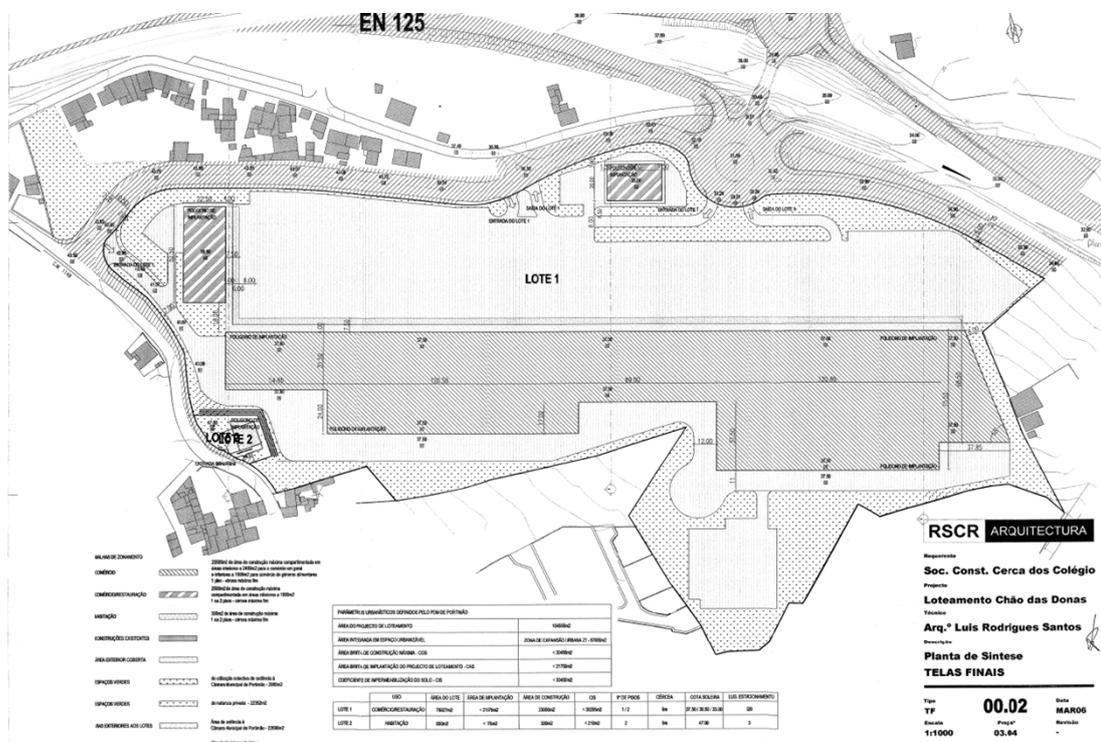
Peça desenhada n.º 00.02 – Planta de Síntese de março de 2006, do Alvará de Loteamento n.º 2/2005.
